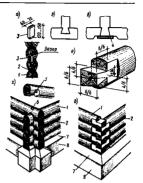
Детали бревенчатых стен; а — сруб на бревен: 6 — сопряжение блевен и бы
